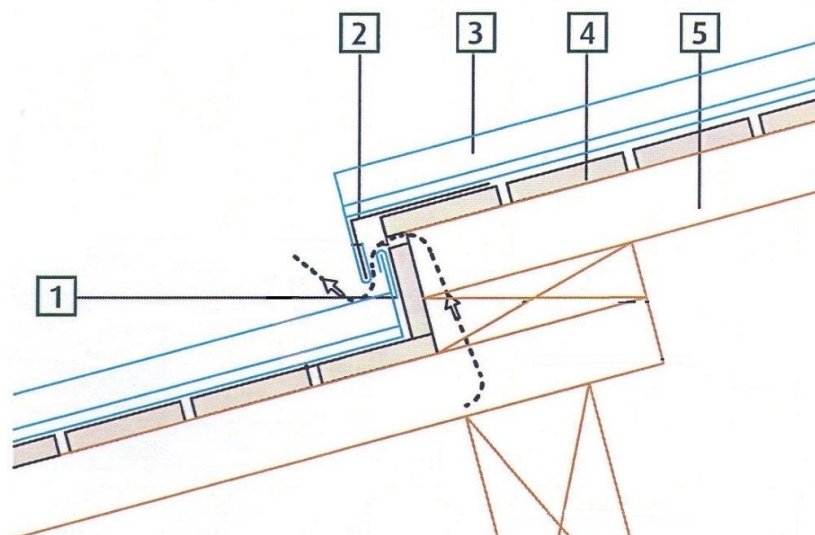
Degrau em cobertura - Sistema Camarinha, 1 e 2 – Presilha, 3 – Placas de revestimento, zinco ou cobre, 4 – Calhas e perfis e 5 – Viga.
